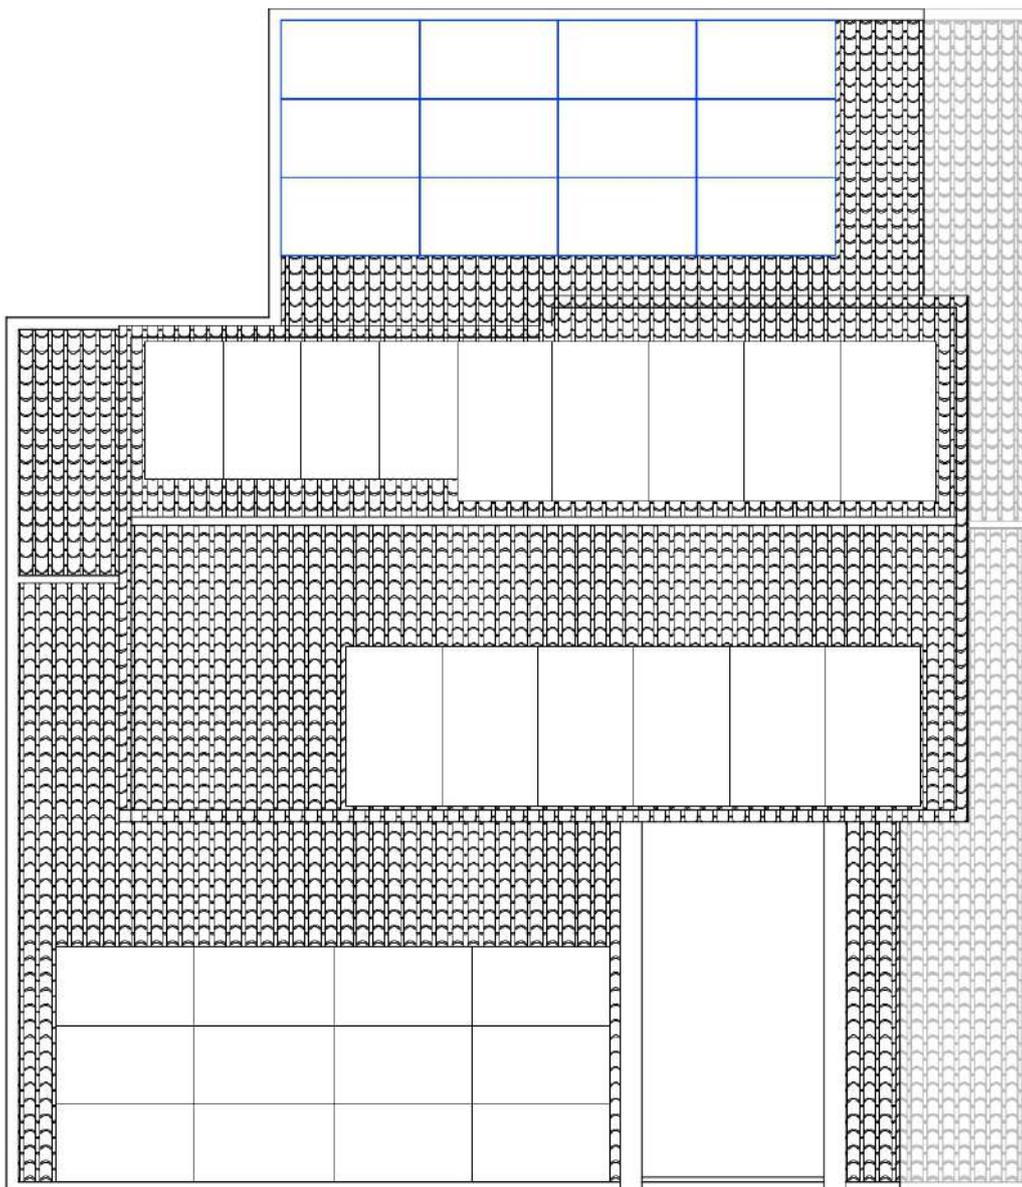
Pianta piano primo: confronto tra stato autorizzato e realizzato.
